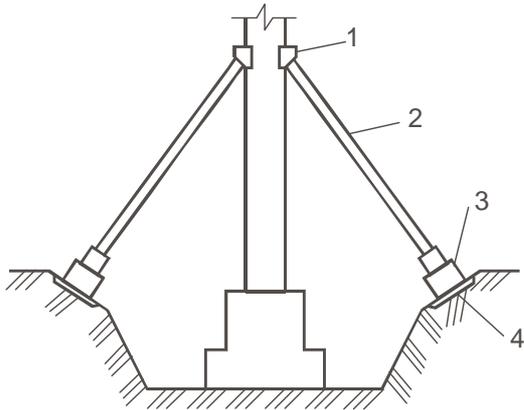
Схема временного крепления стены или колонны при разработке грунта вокруг фундамента: 1 – распределительная балка; 2 – подкос; 3 – домкрат; 4 – распределительная плита
